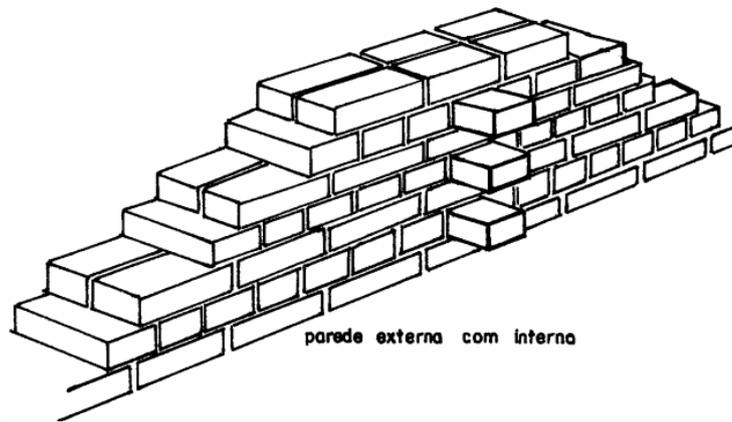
Canto em parede externa de um tijolo com parede interna de meio tijolo no ajuste francês.
